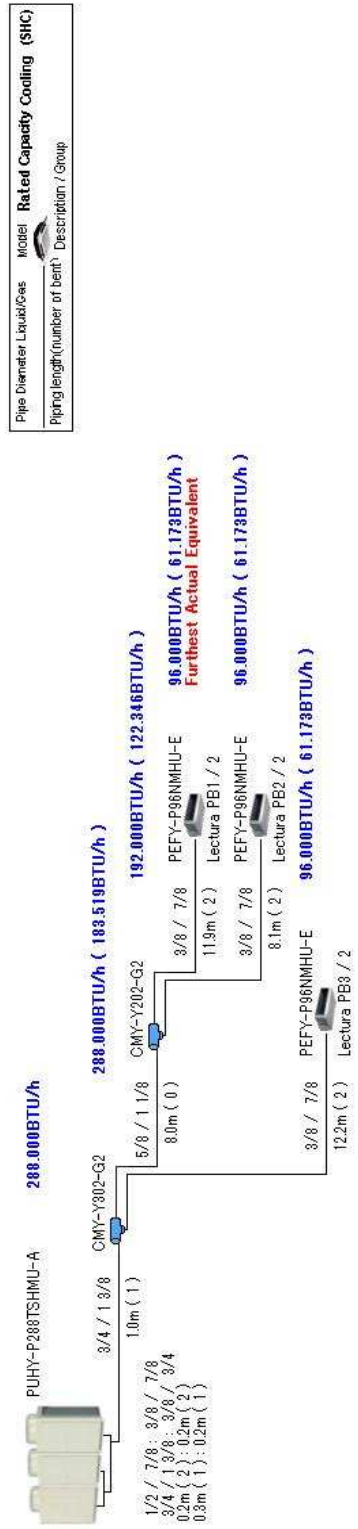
Sistema de Aire Acondicionado Planta Baja 1.
